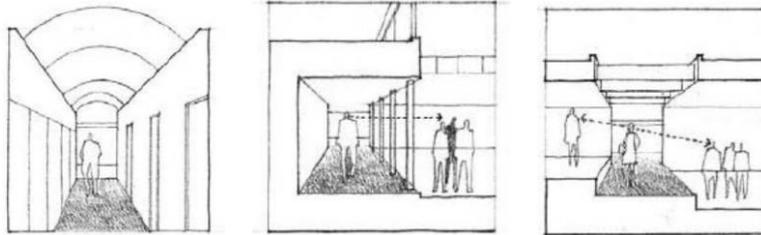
Hubungan dan Jalur dalam Ruang
